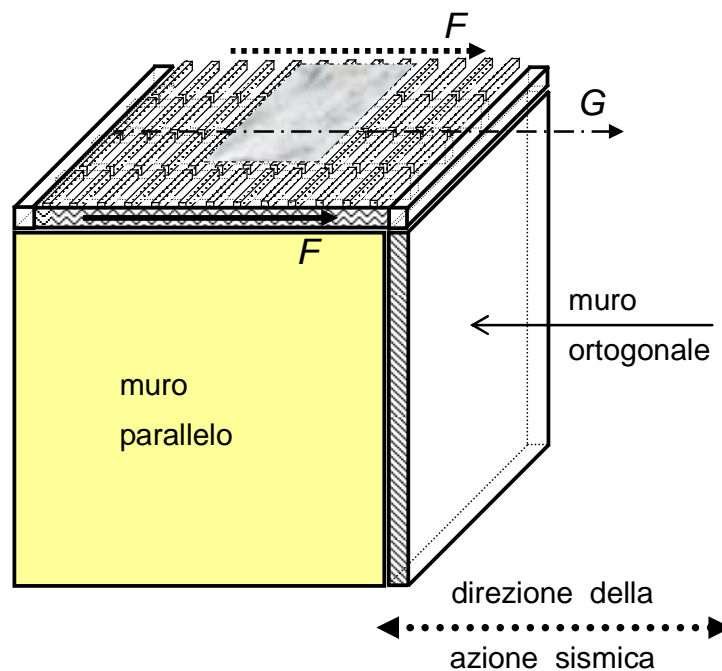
f/2°. La struttura è investita dall'azione sismica la cui direzione è indicata dalla doppia freccia in linea forte, punteggiata. Il solaio (figura e) è rigido nel piano e solidarizzato alle sommità di tutti e quattro i muri d'appoggio. Conseguentemente il solaio scarica l'azione sismica di piano ai muri paralleli all'azione sismica. Pertanto la forza sismica di piano viene assorbita dai muri dotati della maggiore resistenza, come pure della maggiore capacità dissipativa. Nessun muro è quindi interessato da forze ortogonali al proprio piano, in questo schema; nessun muro tende quindi a ribaltare fuori dal piano quando il solaio è irrigidito nel piano e solidarizzato ai muri.
